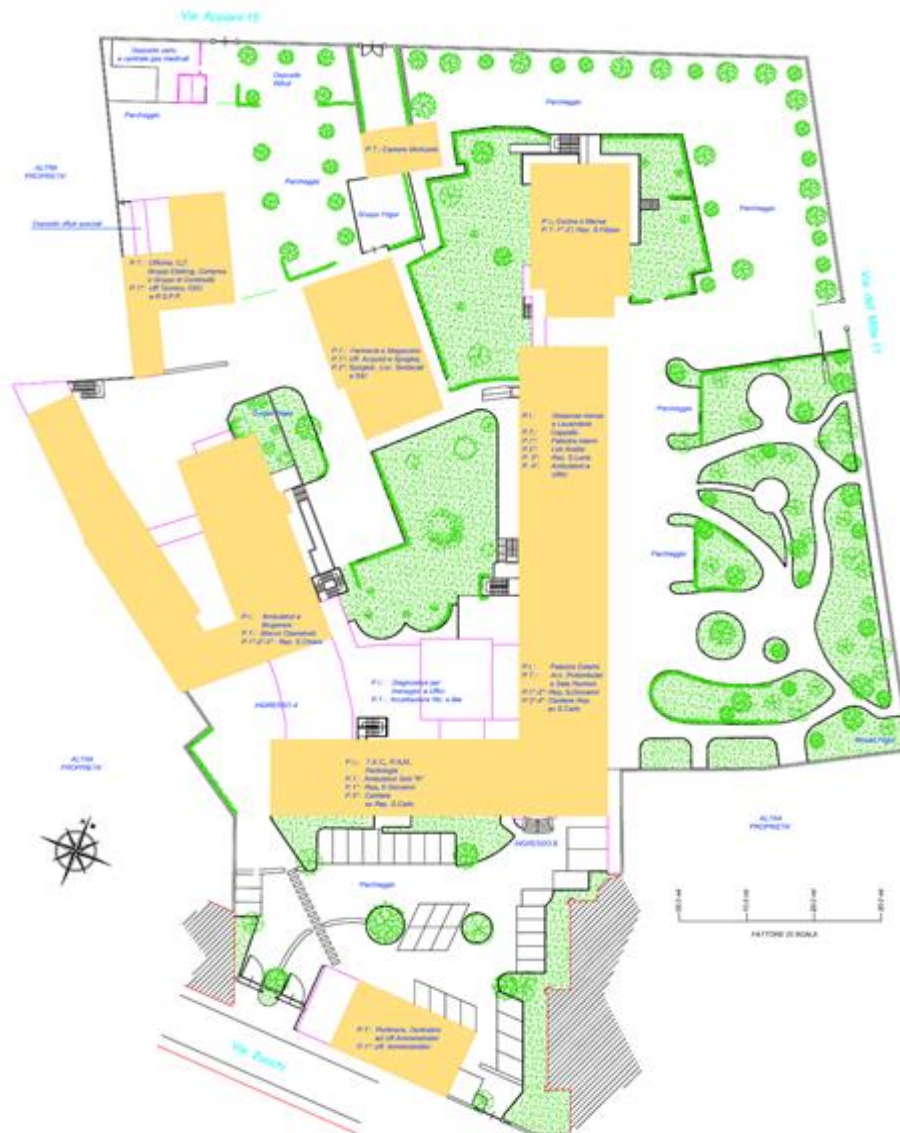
Planimetria generale Istituti Clinici Zucchi.
